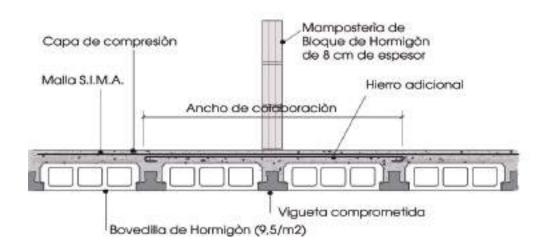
Refuerzos bajo tabique angosto paralelo a viguetas
